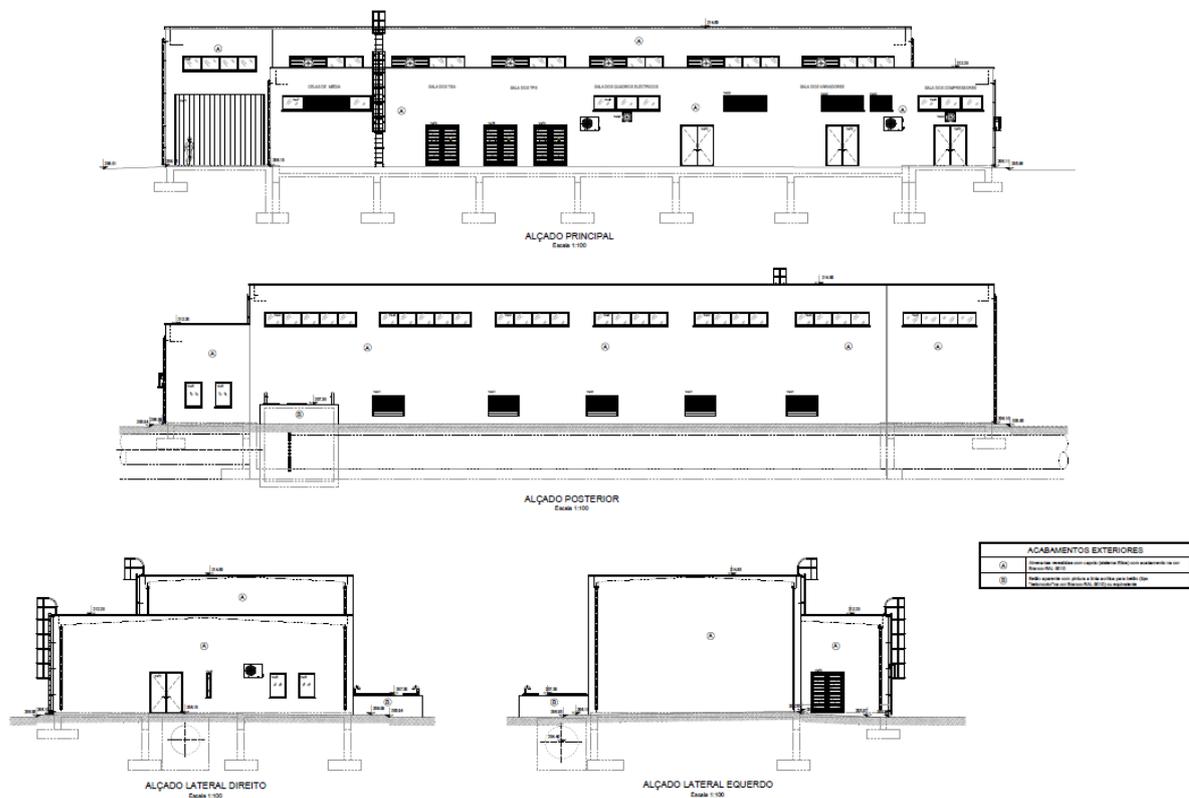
Alçados e acabamentos exteriores do edifício da Estação Elevatória.
